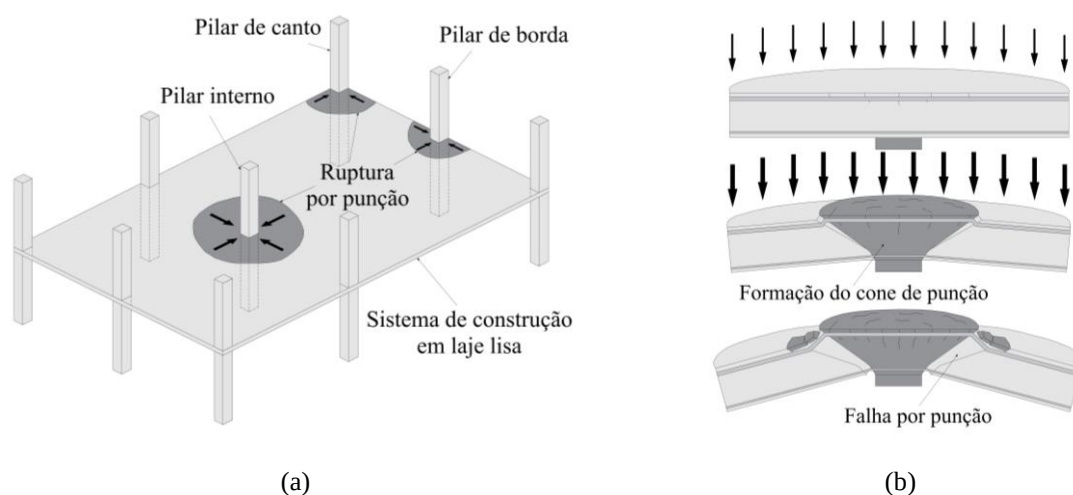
Lajes em concreto armado – (a) sistema estrutural em lajes lisas; (b) Ruptura na ligação laje-pilar (adaptado de Brantschen, 2016)
